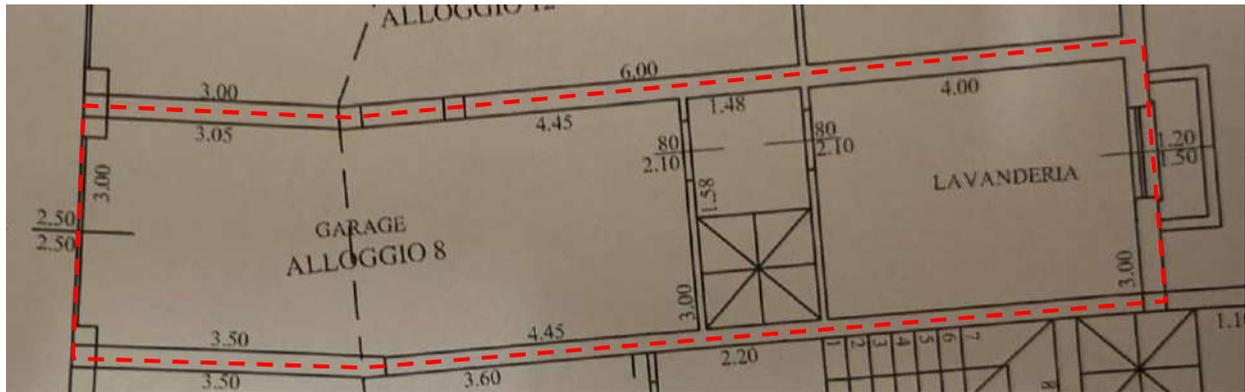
D.I.A. n. 05 Prot. 1315 del 09.02.2005 – Estratto tav. 4 pianta piano interrato con indicazione dell'immobile in oggetto
